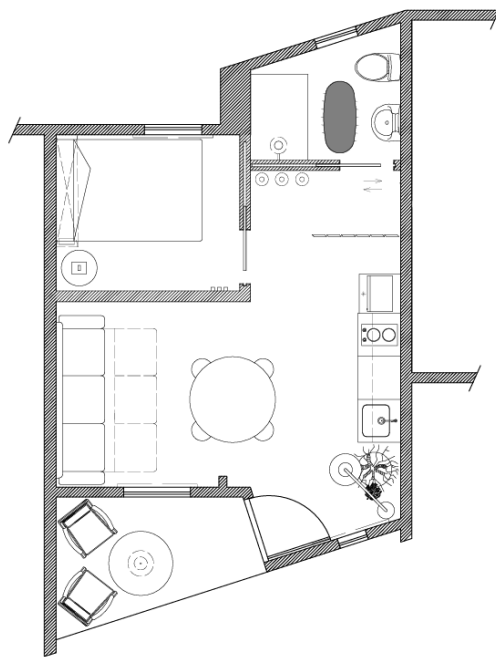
Planta final - *Bungalow 3* (Fonte: autora)
